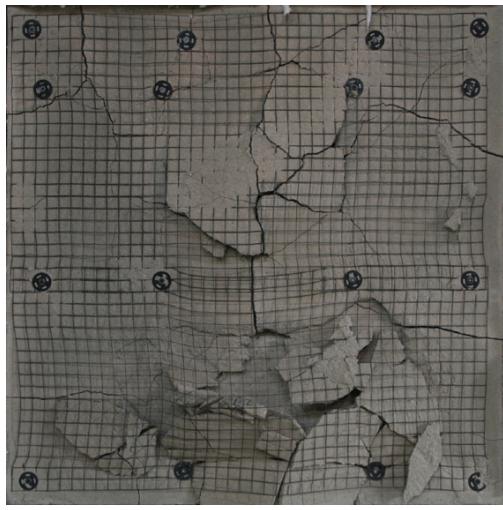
耐火試験後の状況 (No. 4) [P2]
